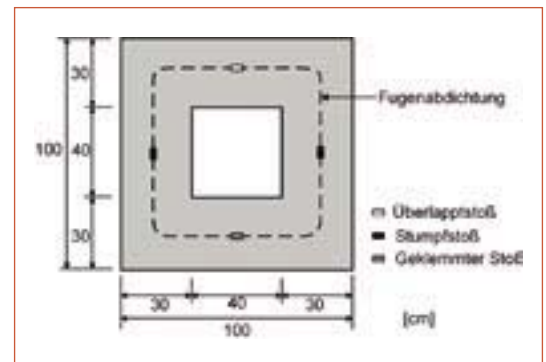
Versuchsaufbau für die Funktionsprüfung beim KAB 125 (Grundriss)
